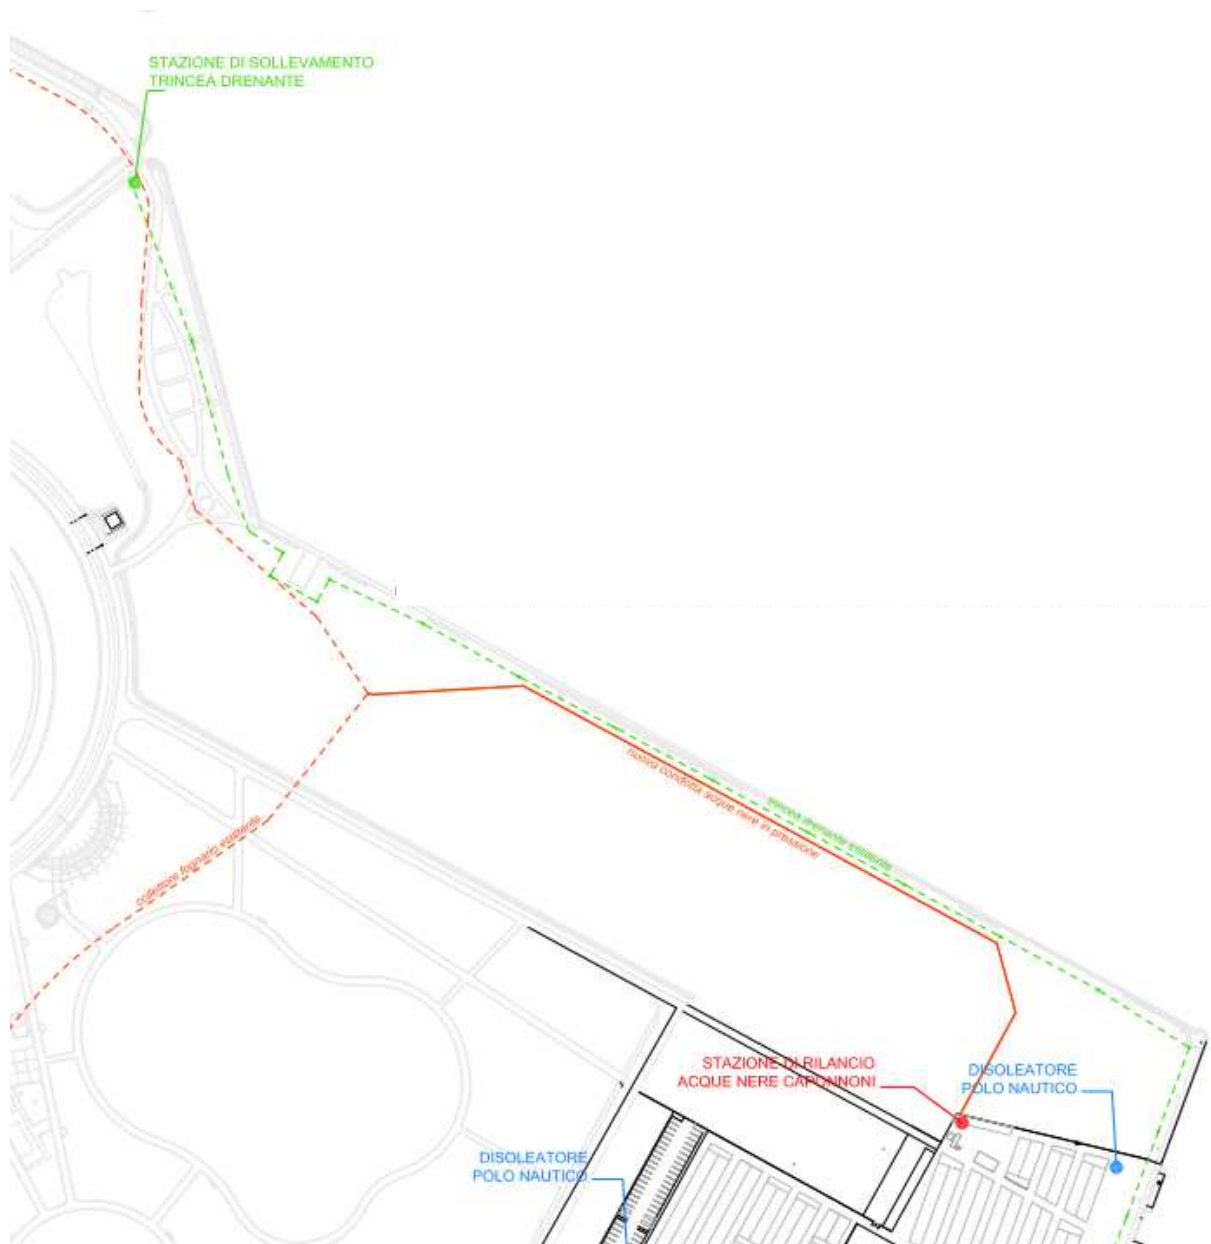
planimetria rete drenante con localizzazione stazione di sollevamento
